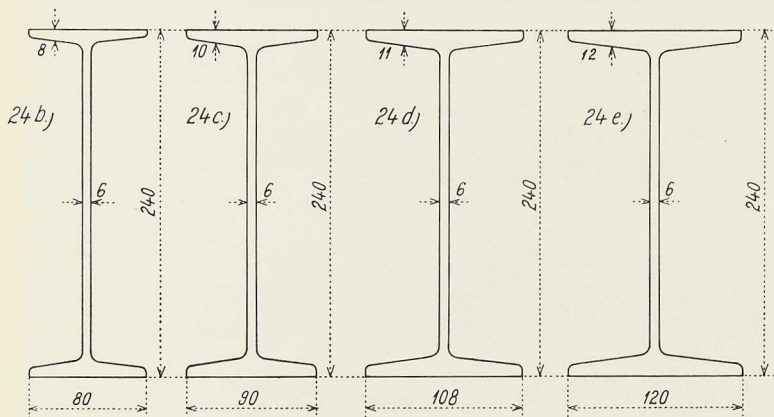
Sections de poutrelles spécialement laminées en Hongrie en vue d'être utilisées comme solives.
